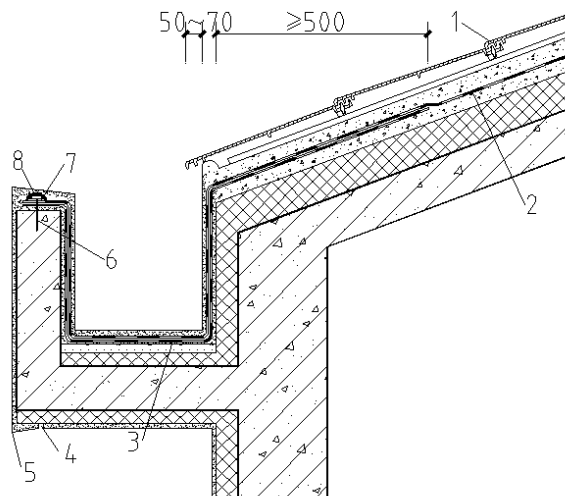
烧结瓦、混凝土瓦屋面檐沟防水构造
